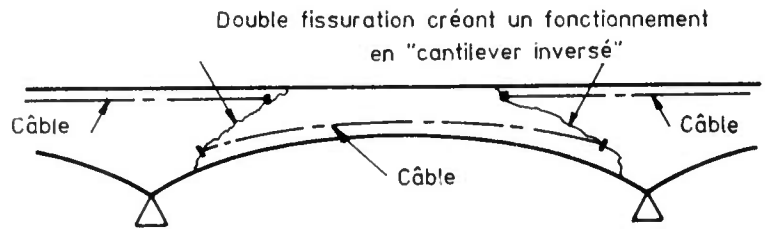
Double fissuration créant un fonctionnement en « cantilever inversé ».
